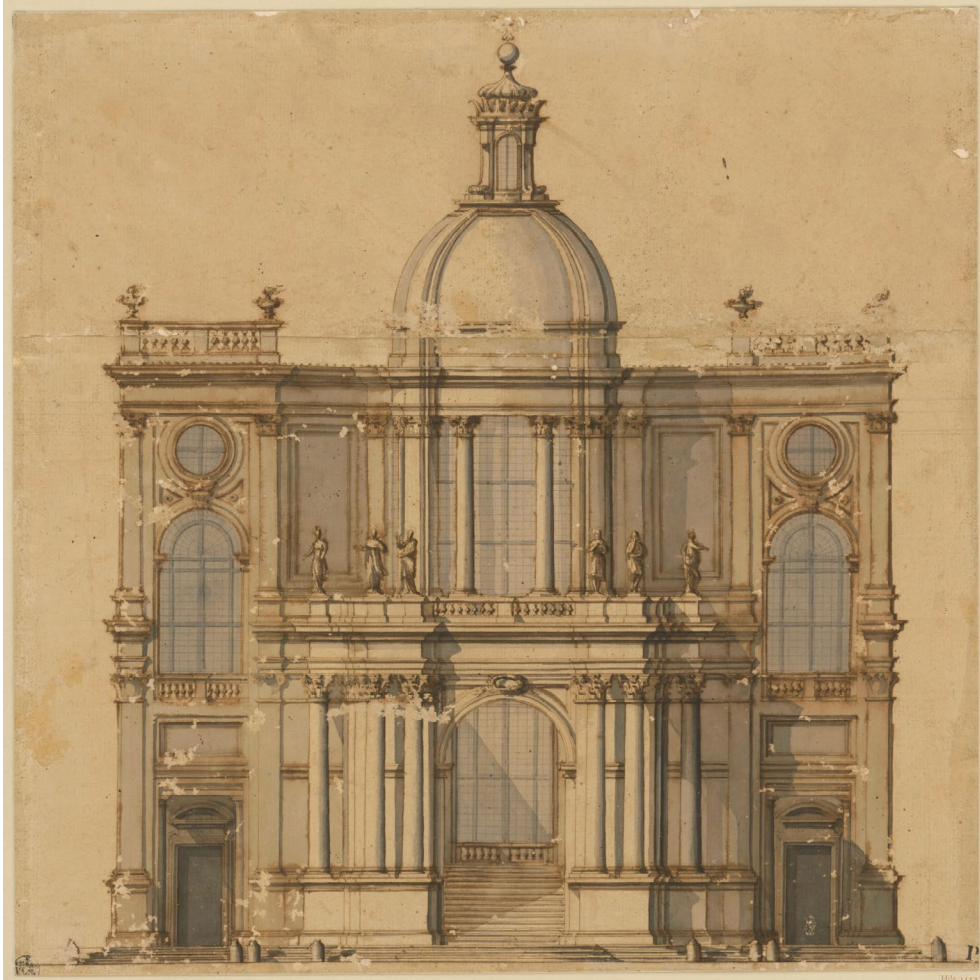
Carlo Fontana, Entwurf für ein Zeremonialtreppenhaus unbekannter königlicher Bestimmung, Fassadenriss, undatiert (1680er Jahre?), grau und blau lavierte Risszeichnung in Bister.
